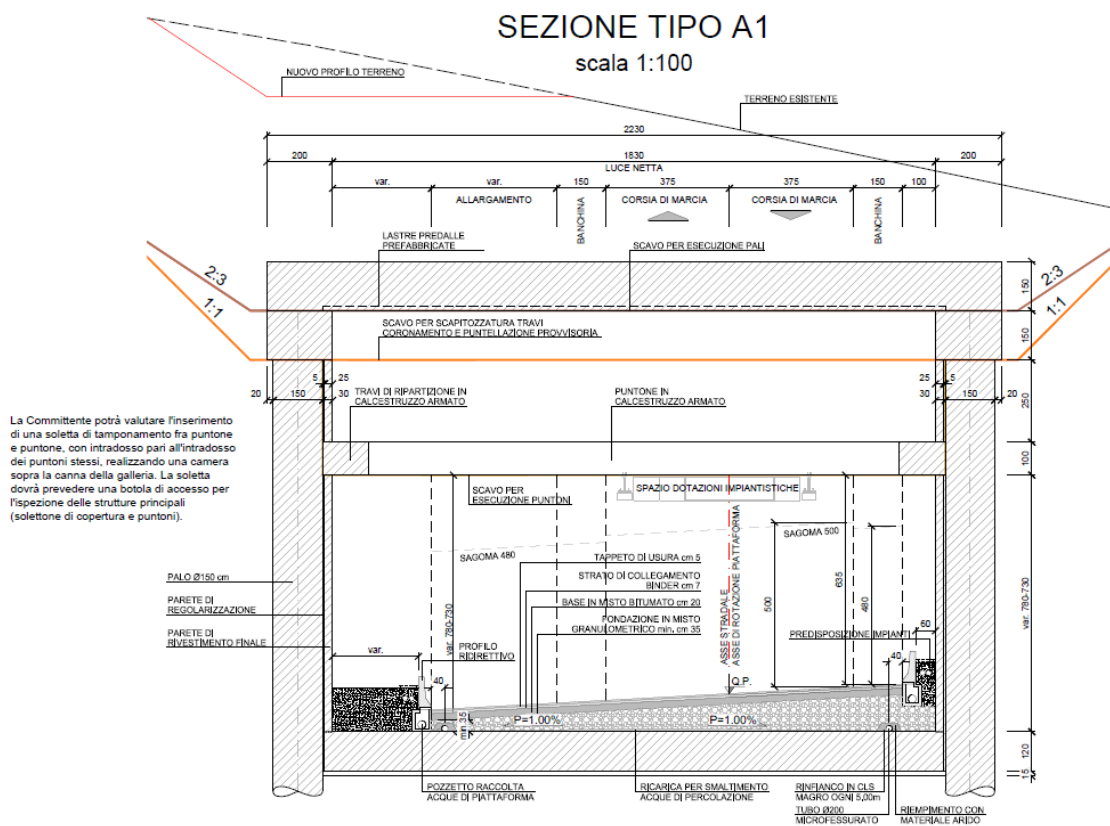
Sezione tipo ad altezza 'rialzata'
